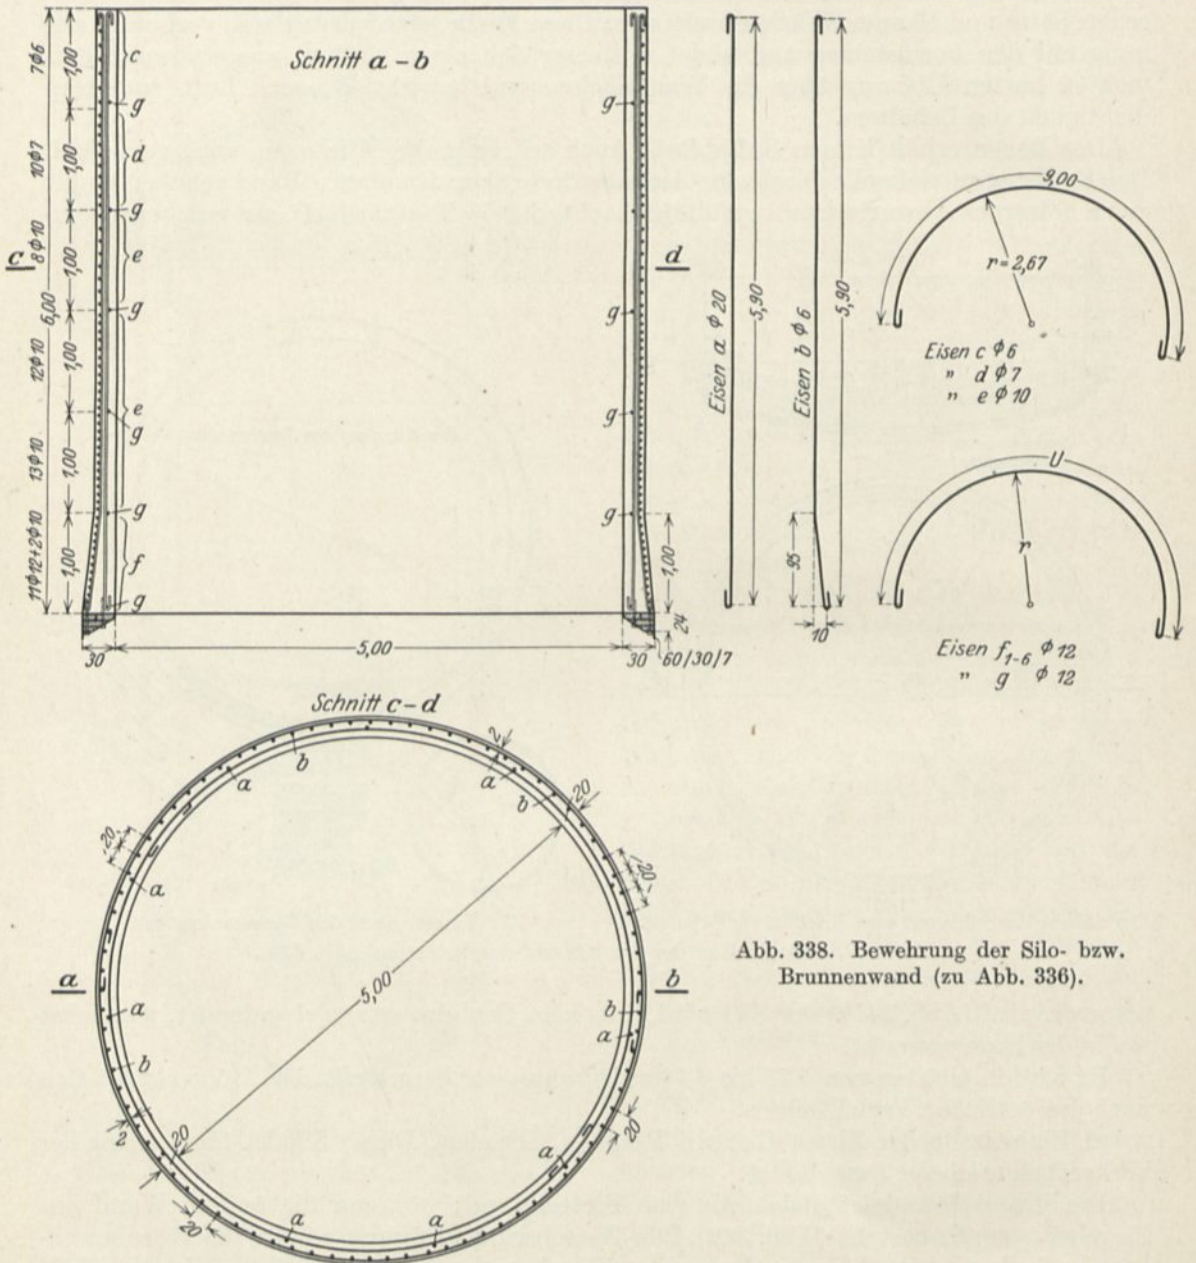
Bewehrung der Silo- bzw. Brunnenwand (zu Abb. 336).
